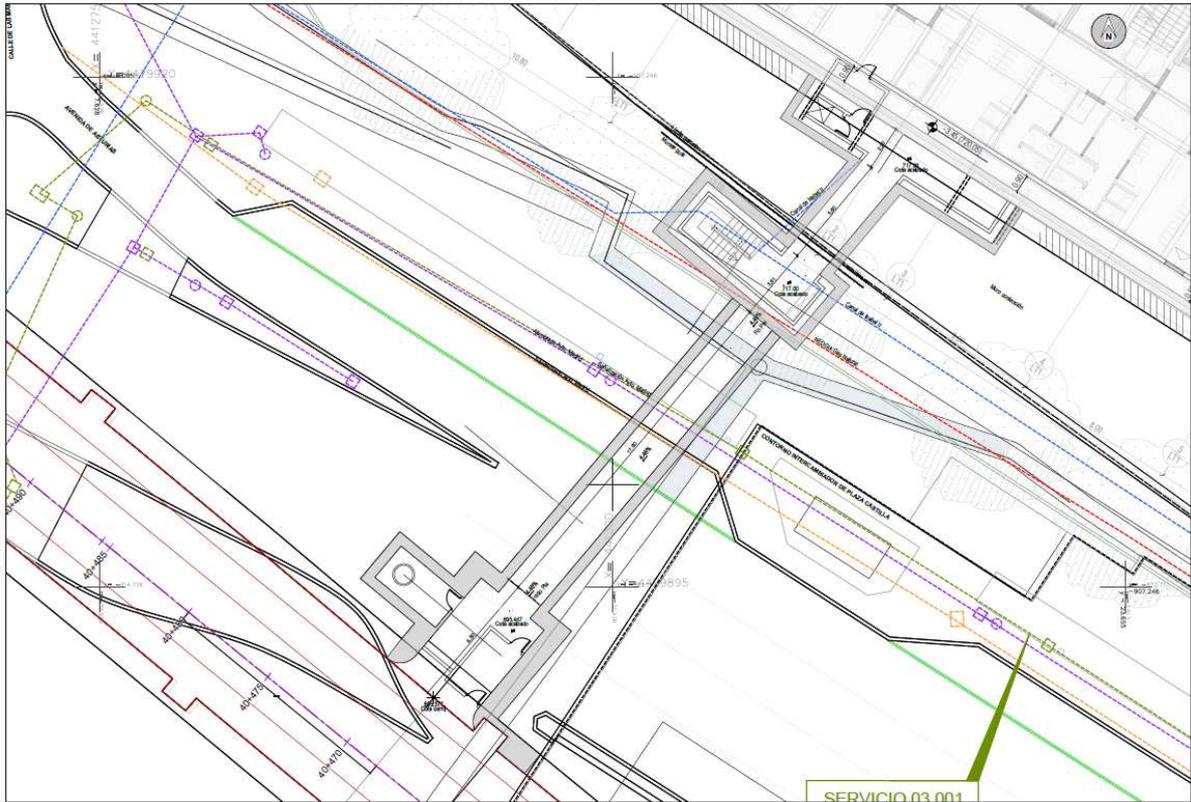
Planta de galería Línea 9 – Edificio 1.
